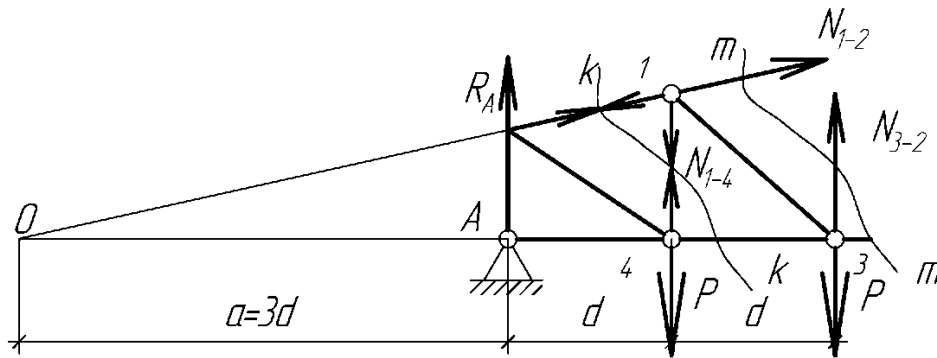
Схема определения усилий в вертикальных стержнях фермы
